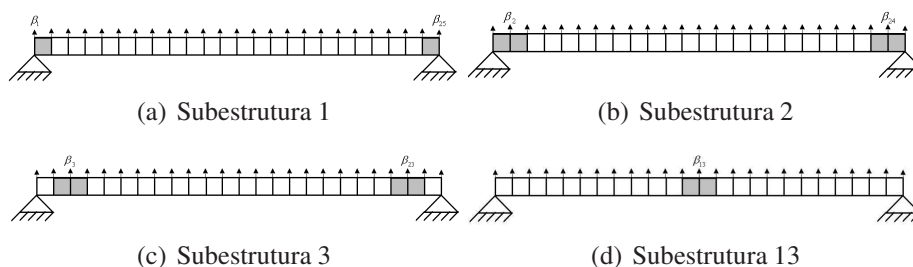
Divisão das subestruturas presentes na viga simplesmente apoiada.
